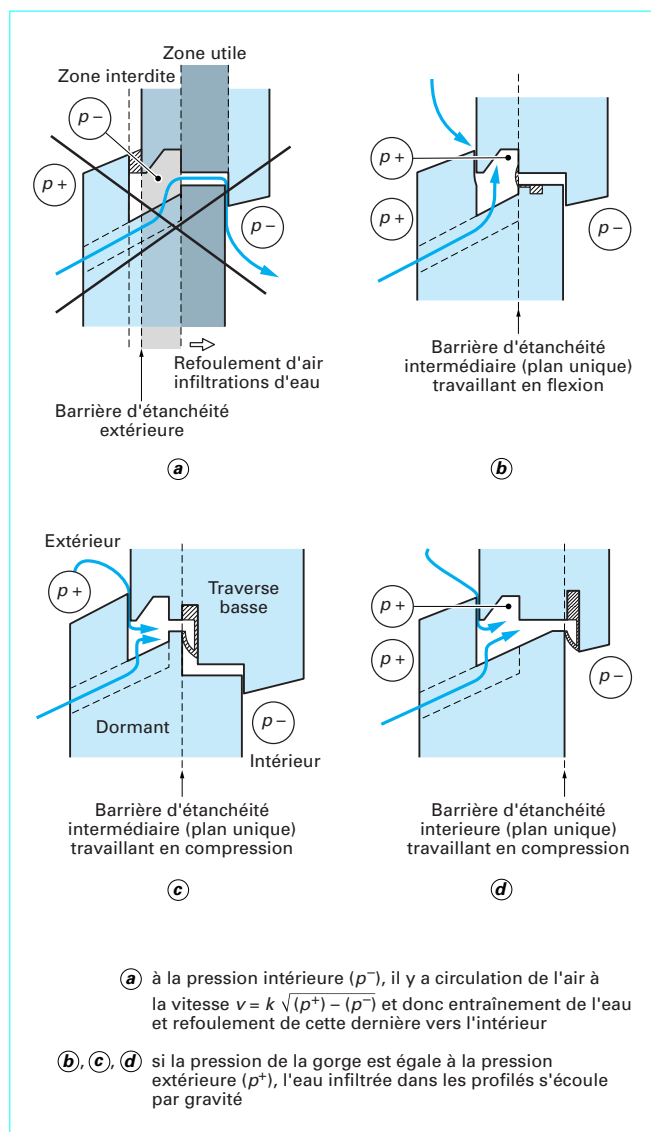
Principe d'étanchéité des ouvrants à frappe (coupe verticale sur la partie inférieure)
